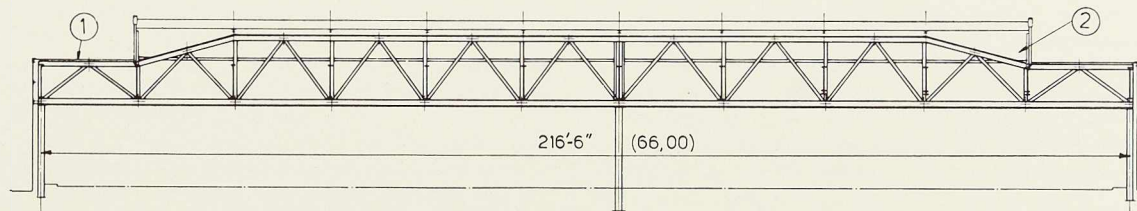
Garage de Loughton. Coupe transversale du parking.
